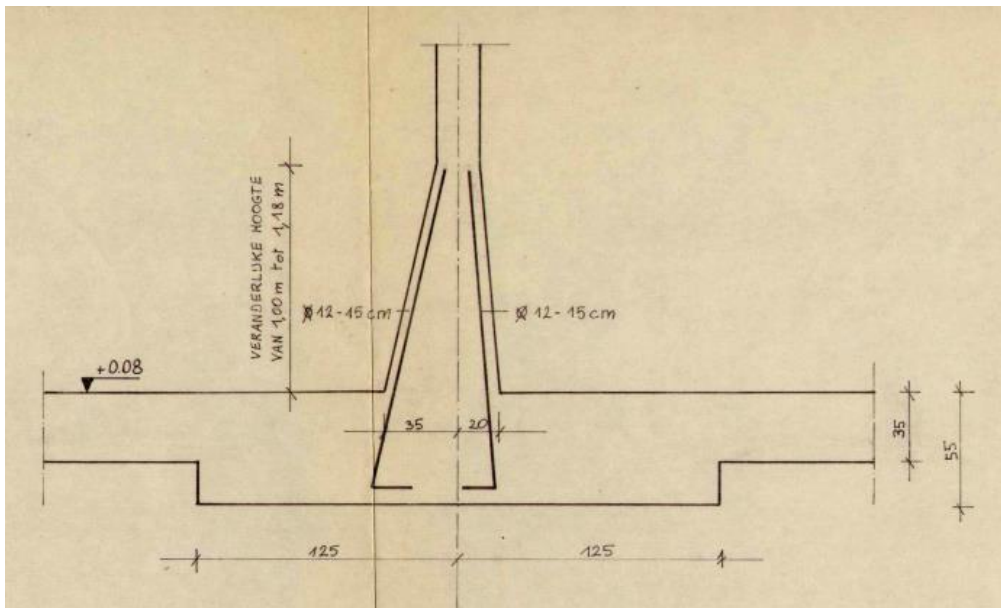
Kopse doorsnede gebouw 2 en gebouw 3 (plan uit 1988, bron: opdrachtgever).
